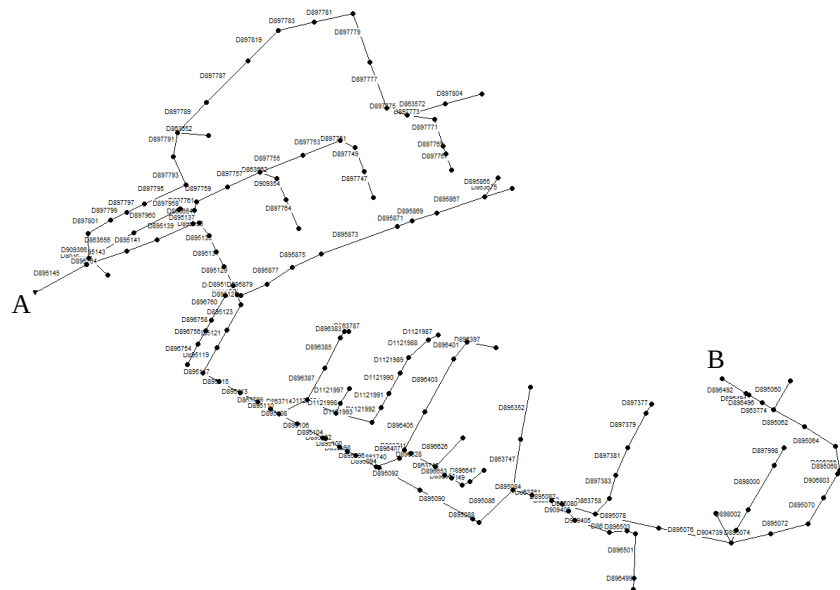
Planta do modelo do sistema de águas residuais domésticas da bacia da Venteira.
